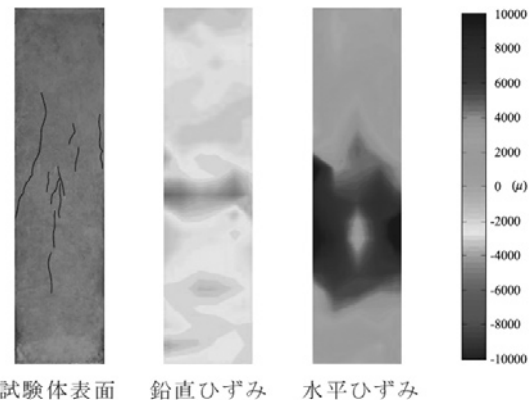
コンクリート試験体のひび割れ後の応力低下域でのコンクリート表面ひずみ
